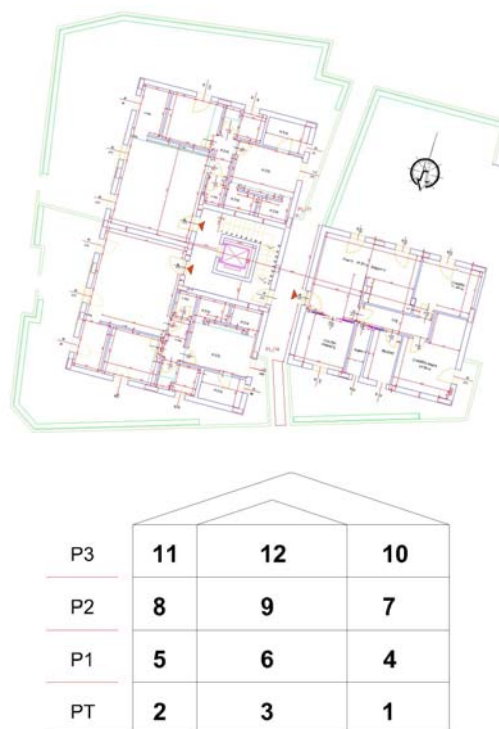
Pianta del piano tipo e schema dell'edificio in linea analizzato
